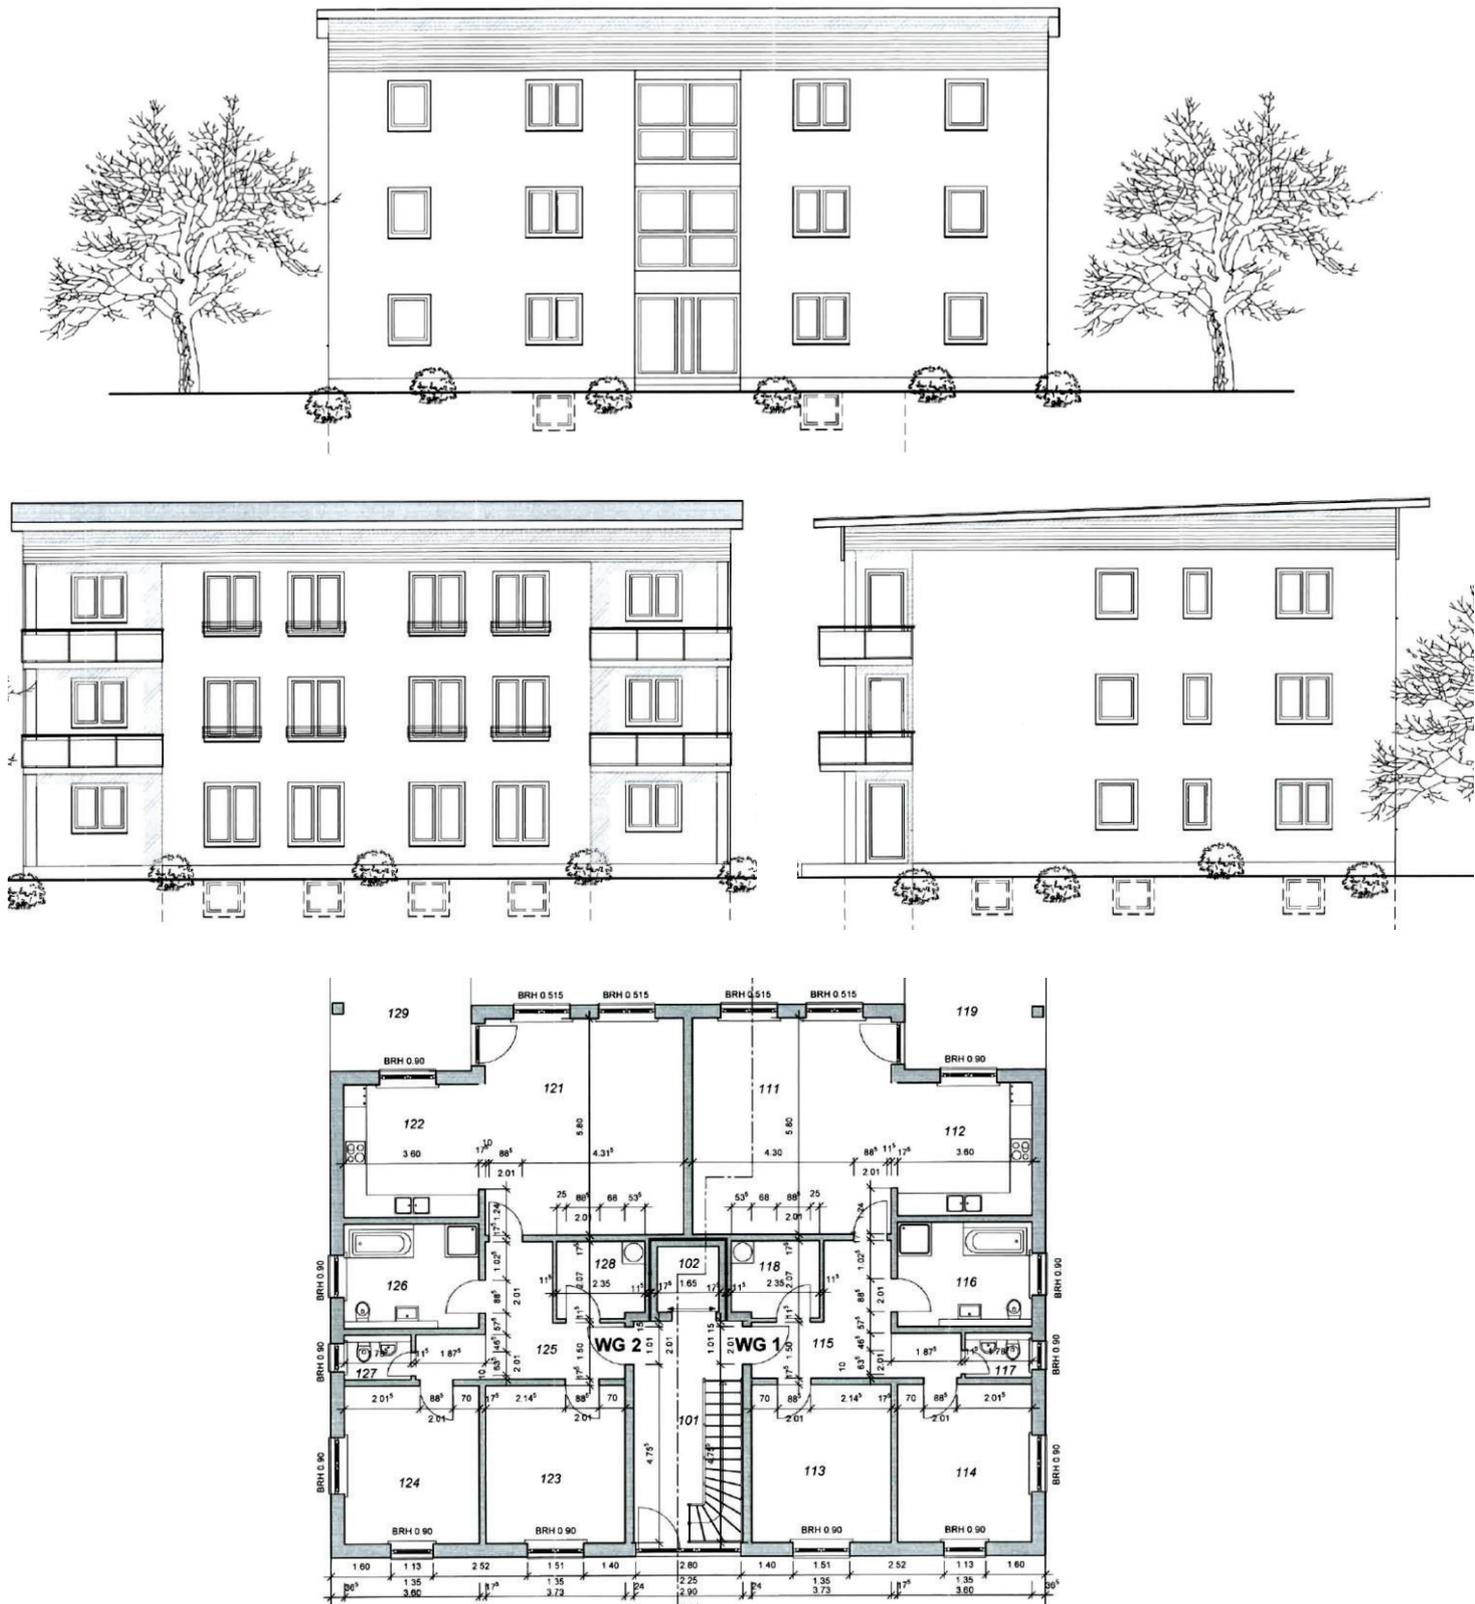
geplante Wohnbebauung, Ansicht von Norden (ganz oben), Süden und Osten (oben)
